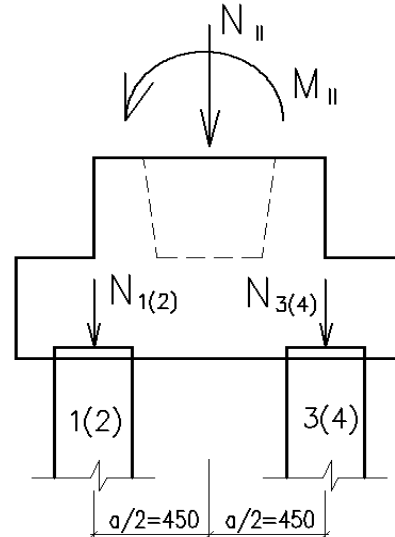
К определению нагрузок, передаваемых на сваи
